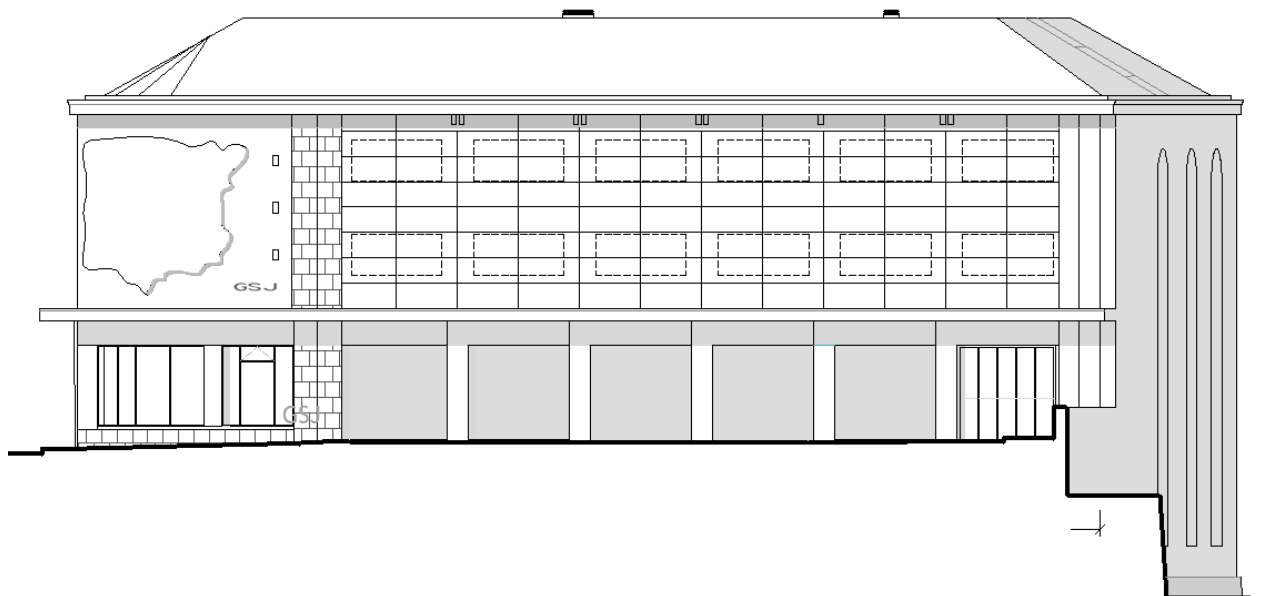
Entrada principal do MeC. Exemplo da fachada com vista do Largo das Forças Armadas.
